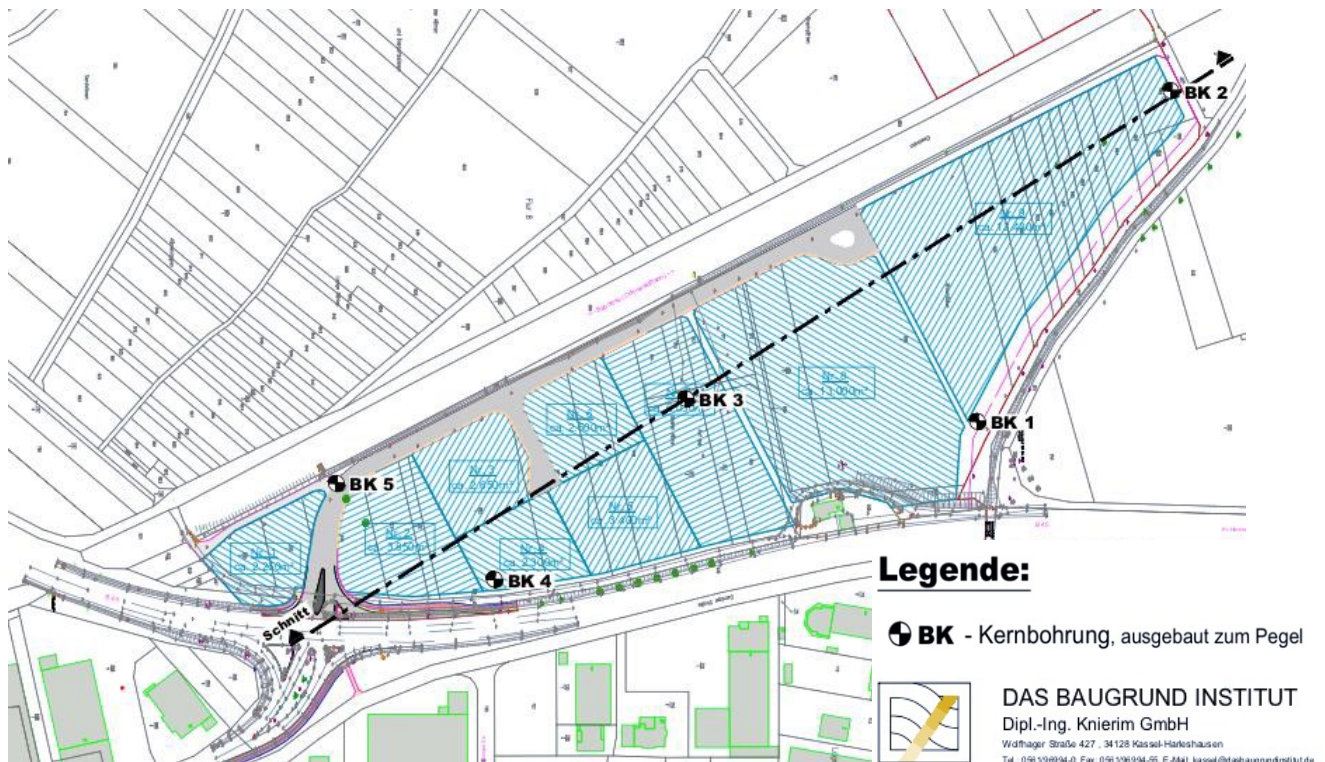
Lageplan Bohrungen/Pegel, Schnittlage
